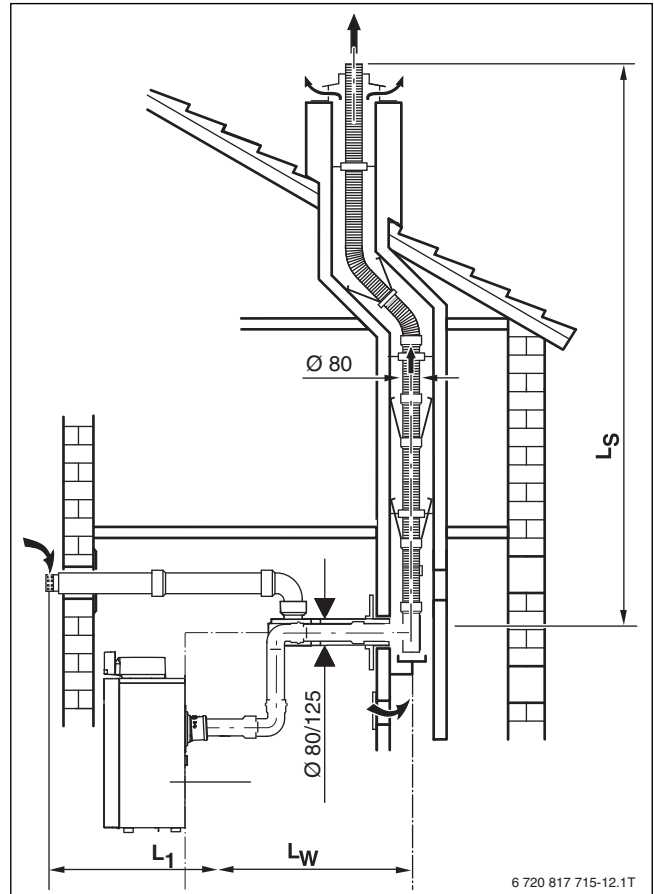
Conducto separado en caja de chimenea, flexible ( $C_{53(x)}$ )
